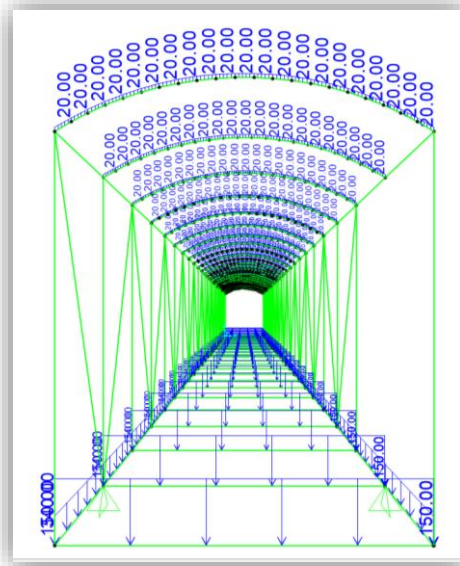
Vista en sección transversal de la estructura con carga muerta permanente (DEAD).
